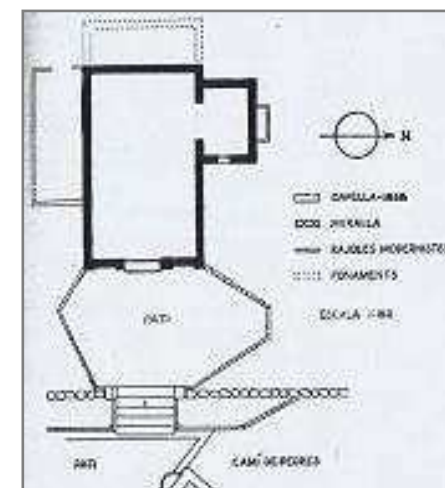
Planta del conjunto de la Capilla de Santa Bárbara. L' Eco de Sitges 1921.
